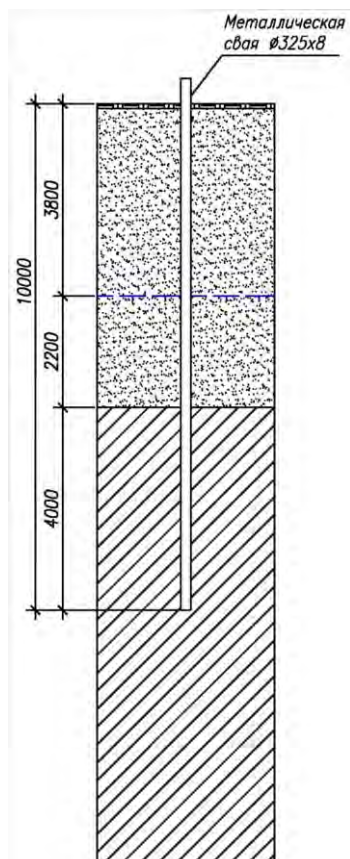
Расположение сваи фундамента длиной 10 м в грунте (для Варианта 1 расчета).
